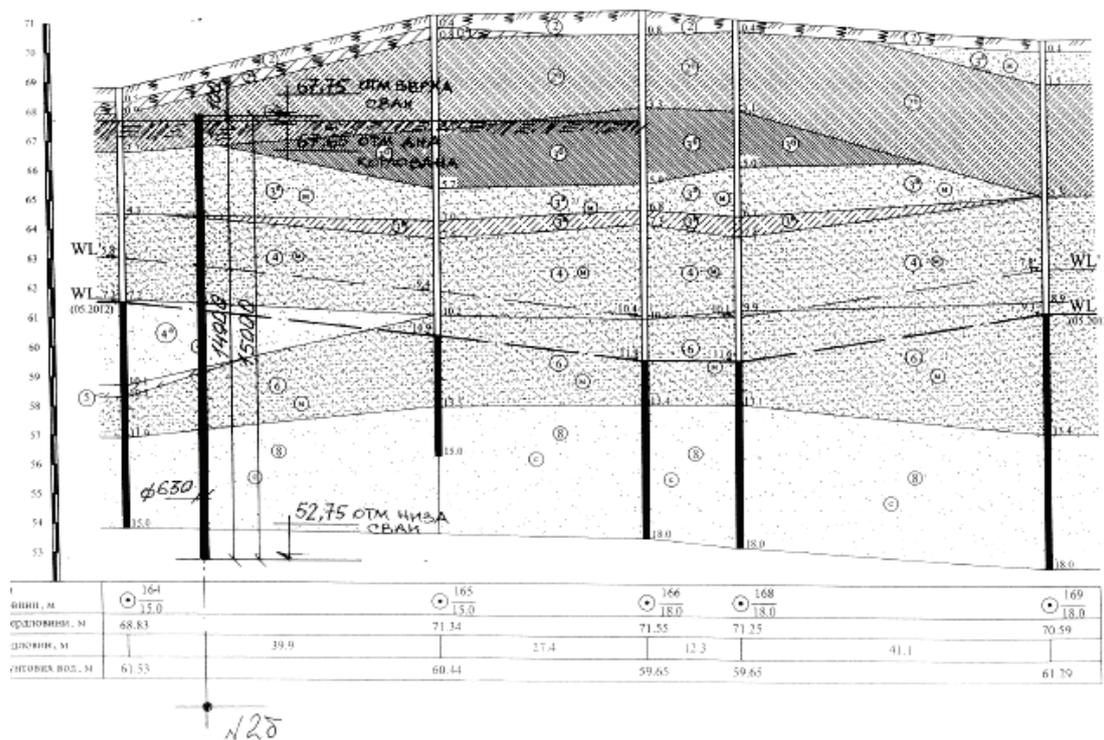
Инженерно-геологический разрез по площадке строительства.
